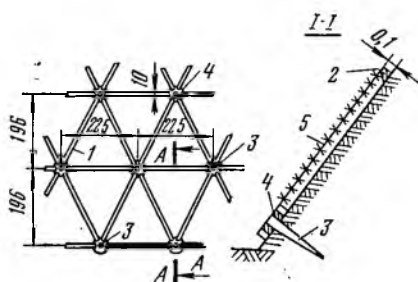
Схема сборных элементов с монтажной плитой:
